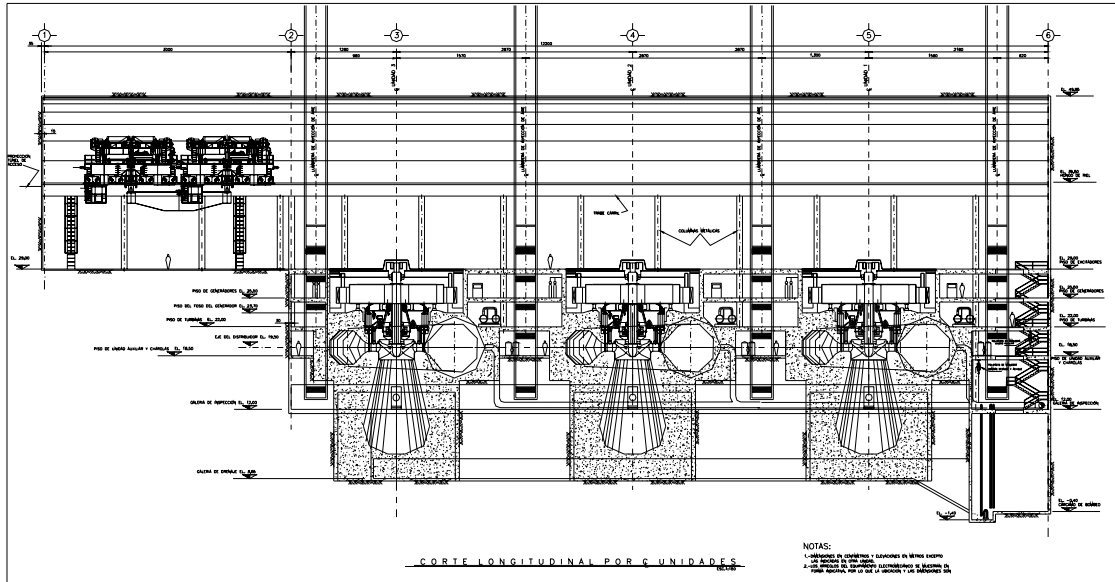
Corte longitudinal de la caverna de casa de máquinas
